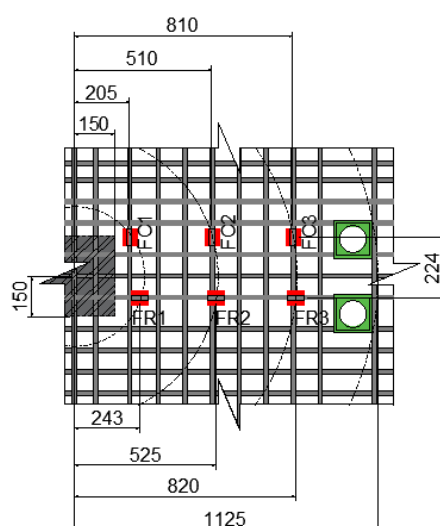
Posicionamento dos extensômetros nas barras de flexão (Autora, 2023).
